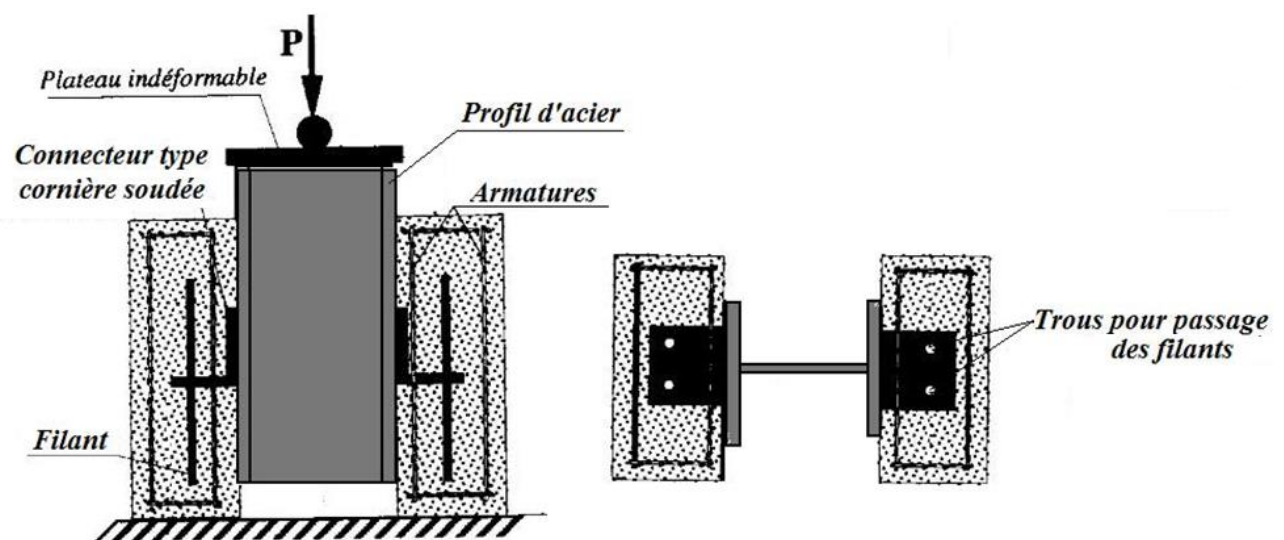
Corps d'essai Push-Out sur un connecteur type cornière avec filant [7]
